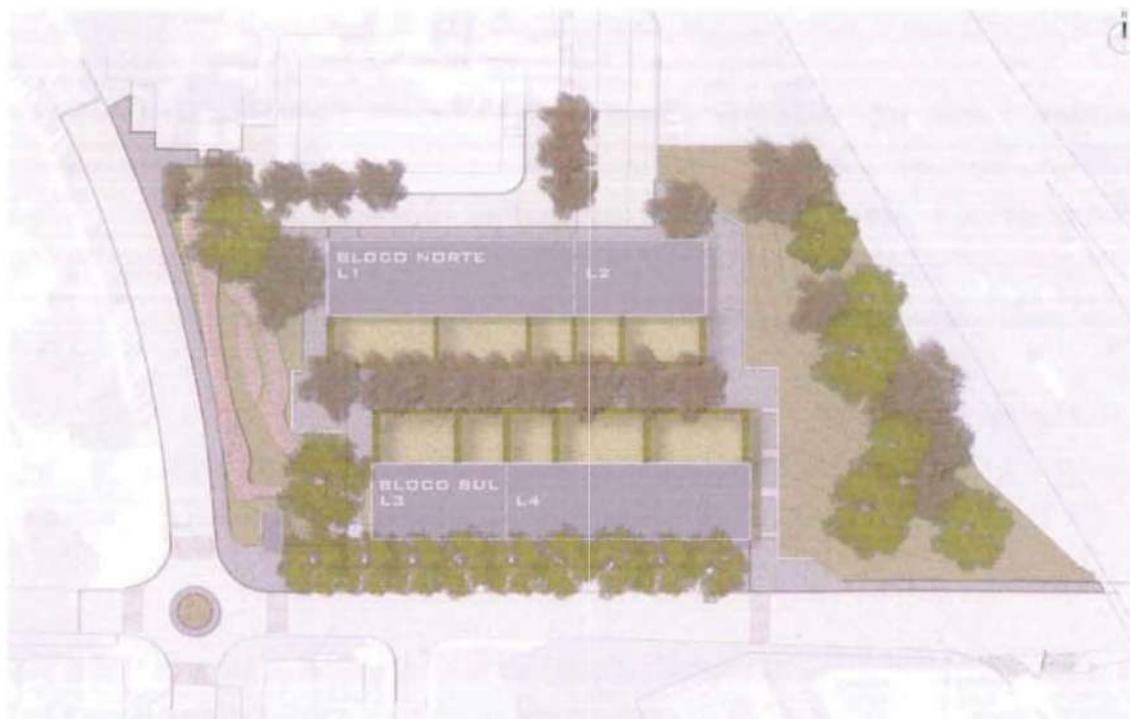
Planta de Apresentação da proposta para a alteração ao Loteamento
